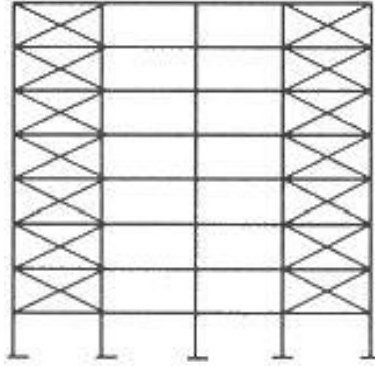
Planta baja débil o flexible [Bazán, E., Meli, R. (2002)]
